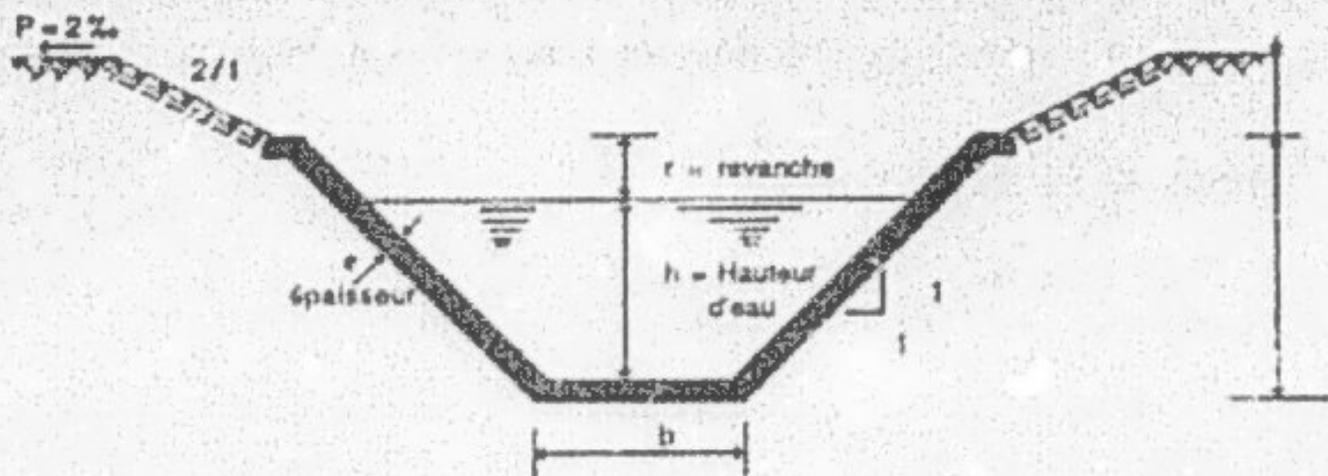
Section transversale type d'un canal trapézoïdal revêtu
